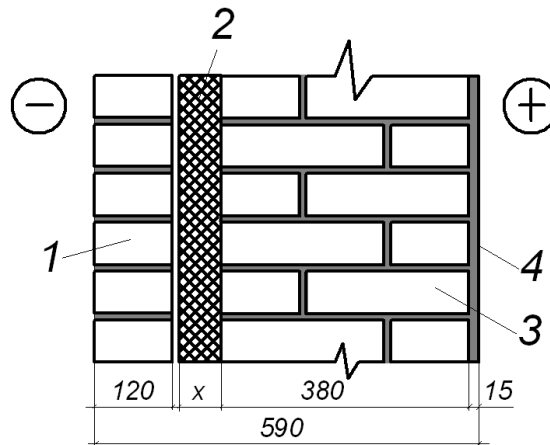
розрахункова схема утеплення зовнішньої стіни будівлі:
